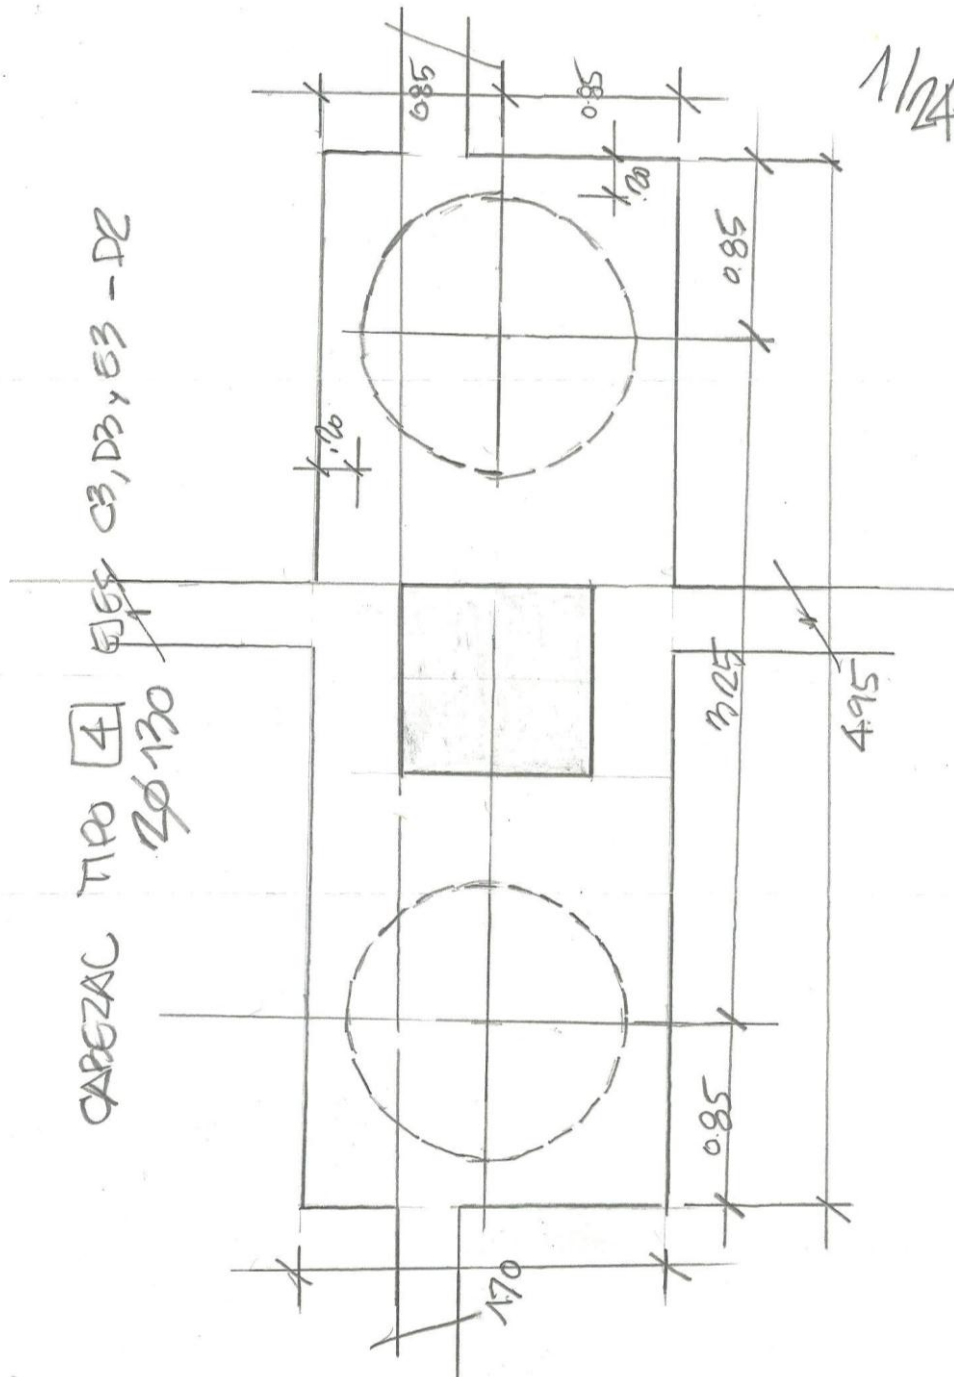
Vista en planta de cabezal típico sobre dos pilotes.
